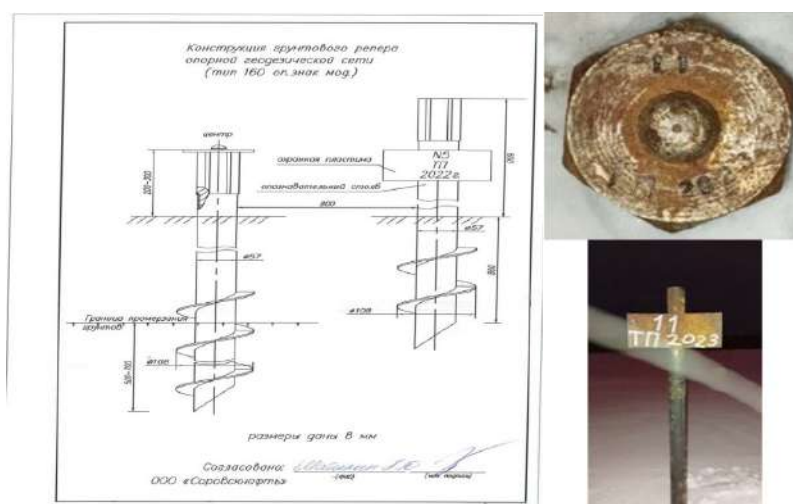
Конструкция грунтового репера опорной геодезической сети в условиях распространения грядово-мочажинных болот
